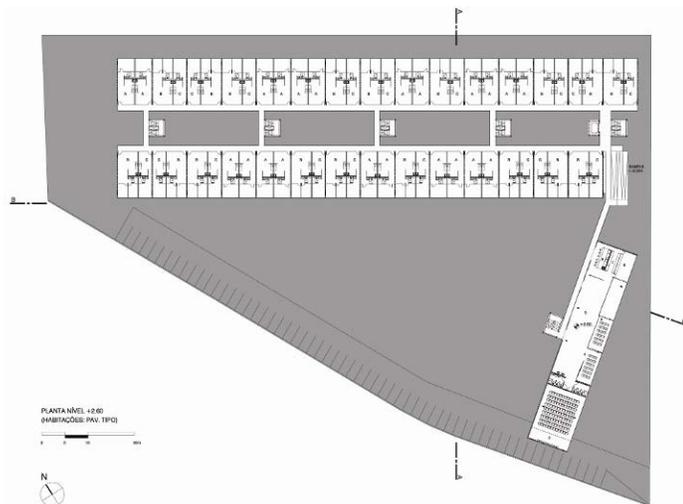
Planta: pavimento-tipo (s/esc).
